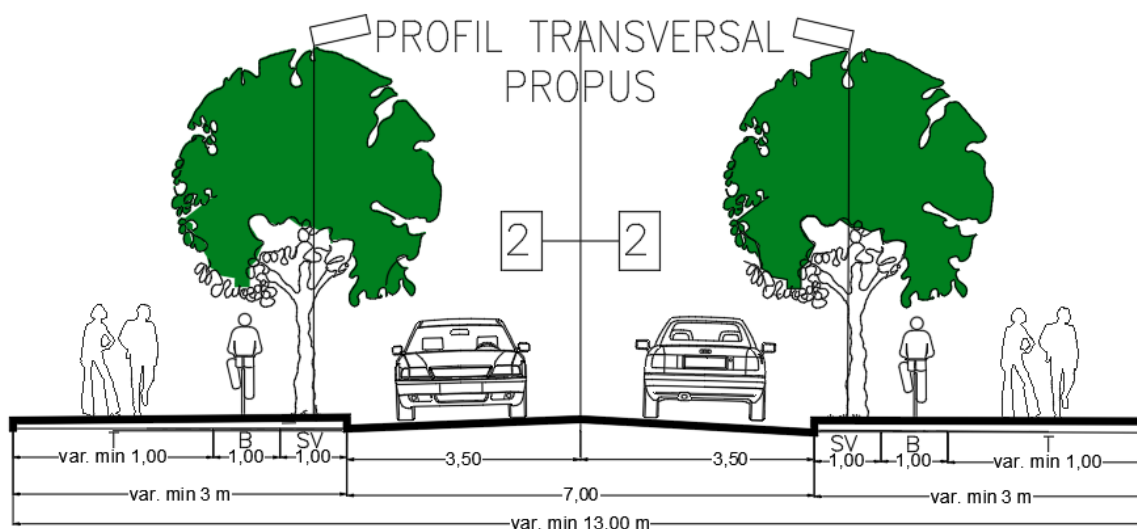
Profil trasversal propus pentru artere secundare de circulație
